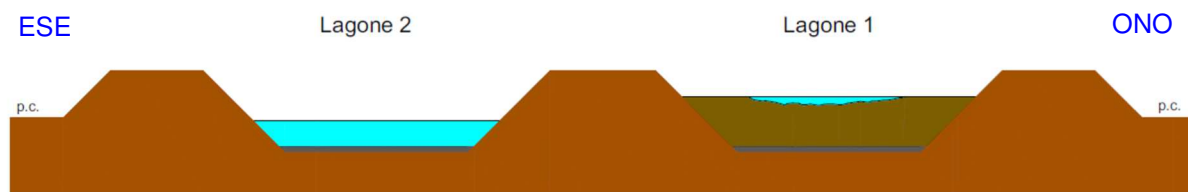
Sezione schematica Lagone 2 – Lagone 1
